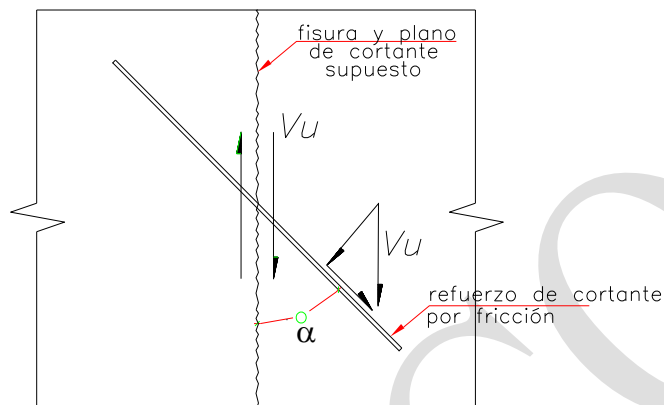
Refuerzo de cortante por fricción inclinado con respecto a la fisura supuesta.
